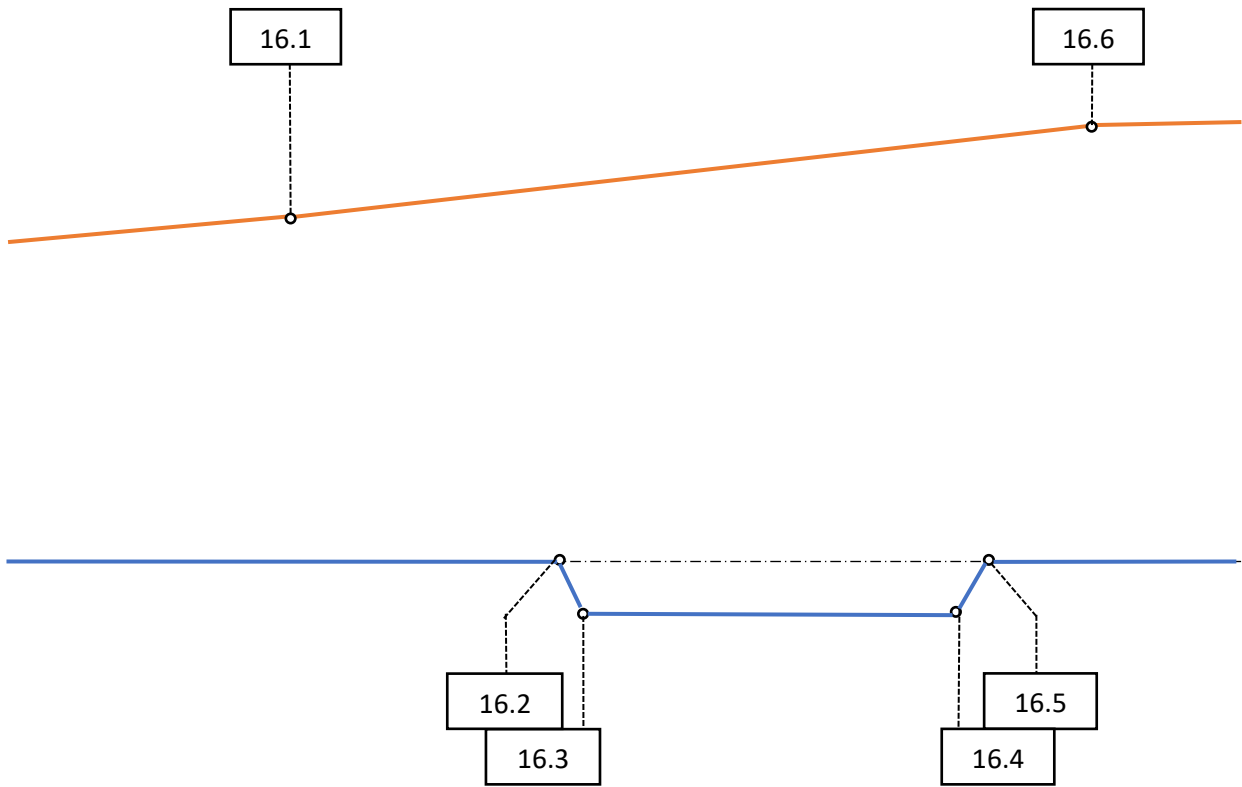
Alzado y planta del tramo XVI. Datos geométricos en la tabla V.16.
